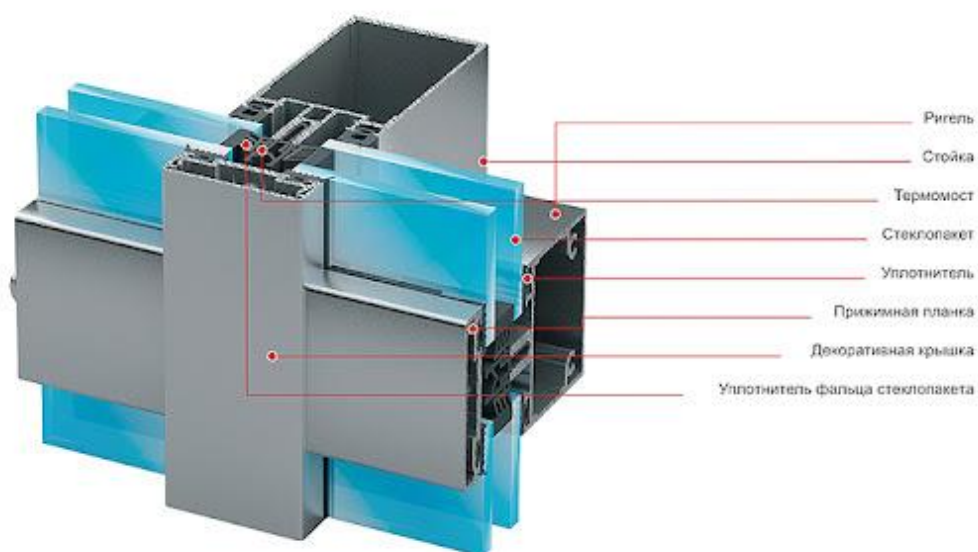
фрагмент стійко-ригельної системи фасадного скління
